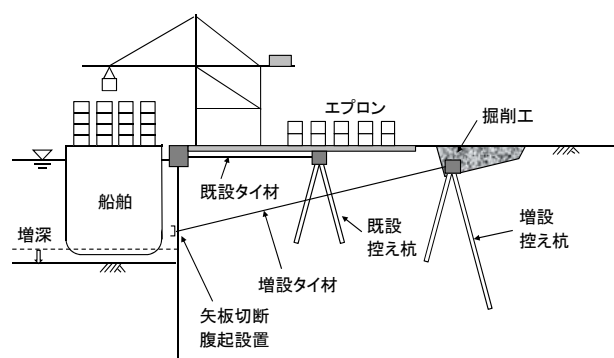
2段タイ地下施工法の概念図¹⁴⁾を再構成
